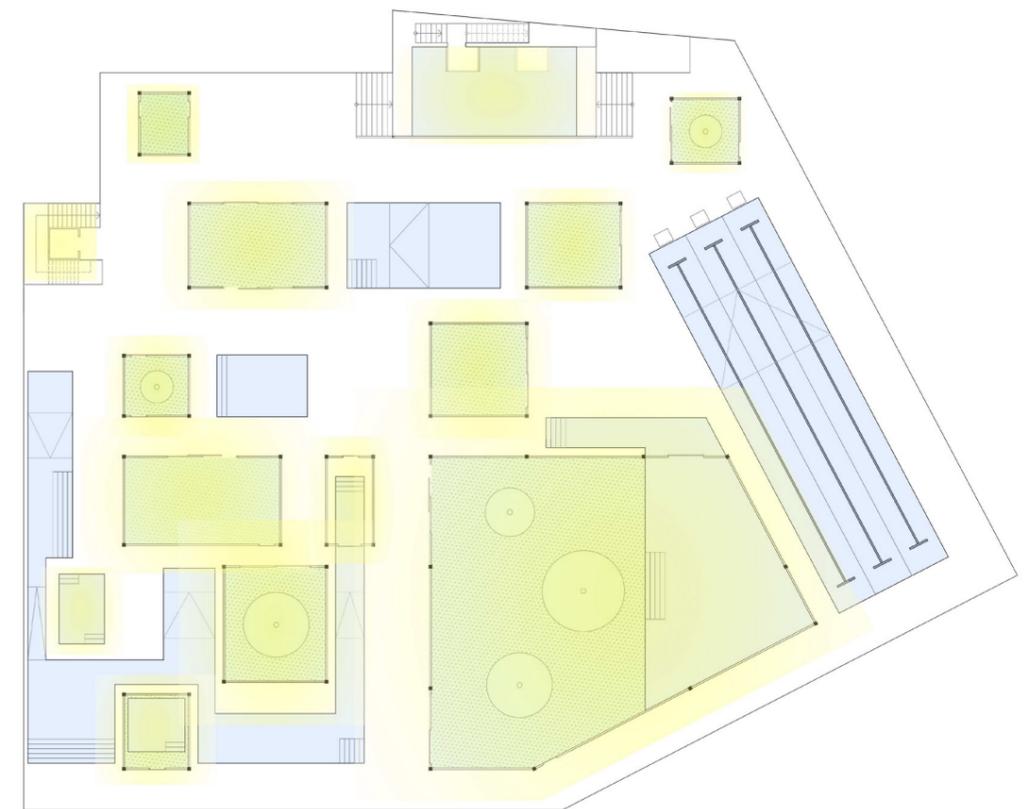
Grundriss Badehalle - Belichtung Atrien und Dachverglasungen
